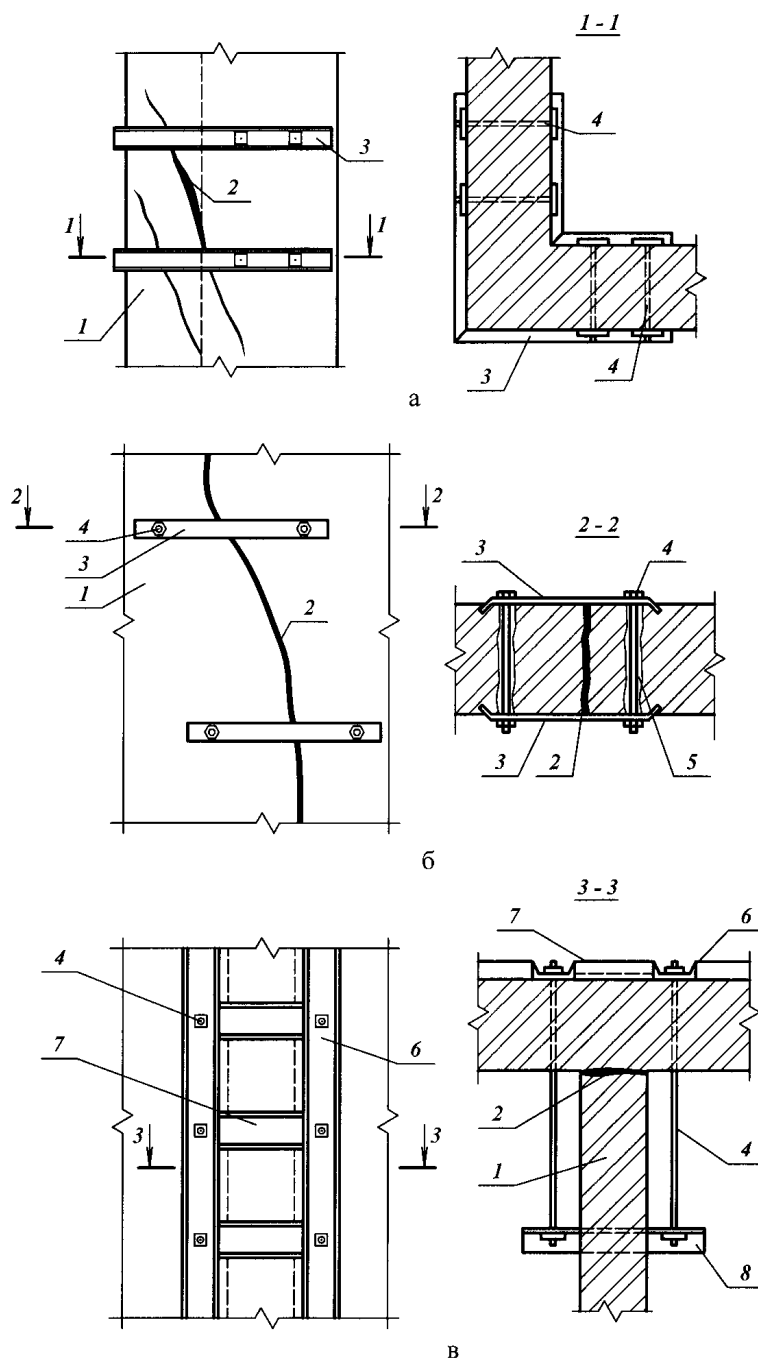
Усиление стен из каменной кладки в зоне локальных трещин:
